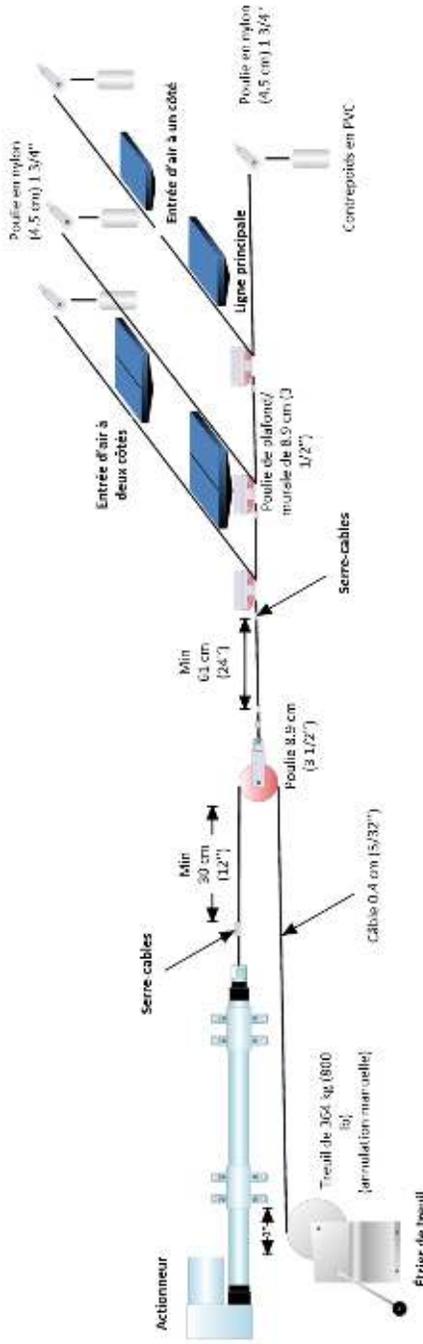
Diagramme d'installation pour entrée d'air au plafond
